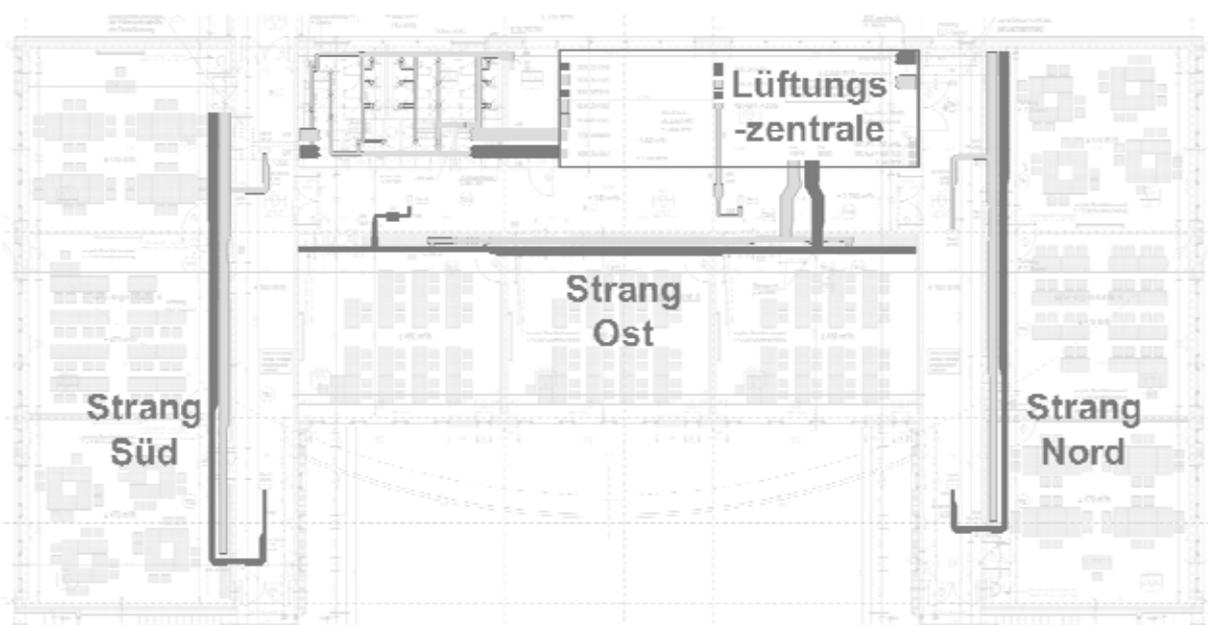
Grundriss des 2.OG der Albert-Schweitzer-Schule (Alsfeld) mit kurzen Zu- und Abluftkanalführungen. Architektur: BLFP, Friedberg / Haustechnik: Neuplan, Gießen (Quelle: [AkkP 33]).
